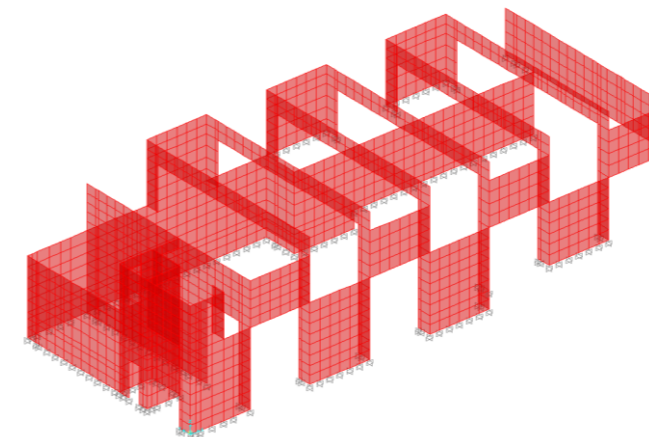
Muros en SAP y parámetros de la sección Muro HA30 20cm
